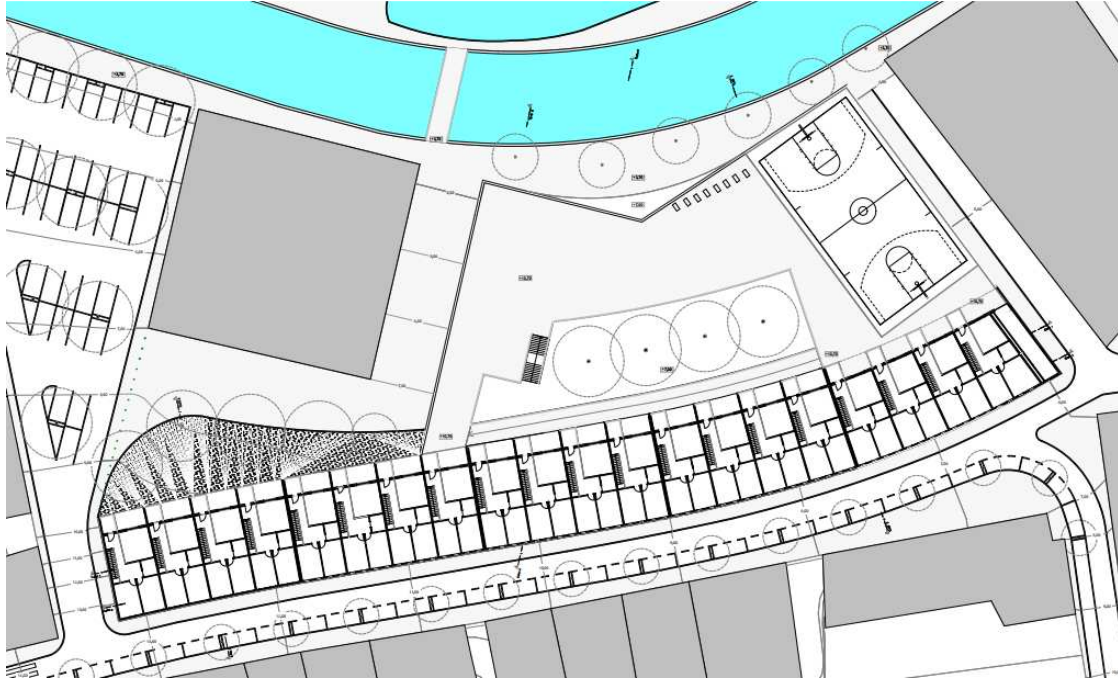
Painel final n.º6 - Habitação colectiva para jovens – Planta do 2º andar
